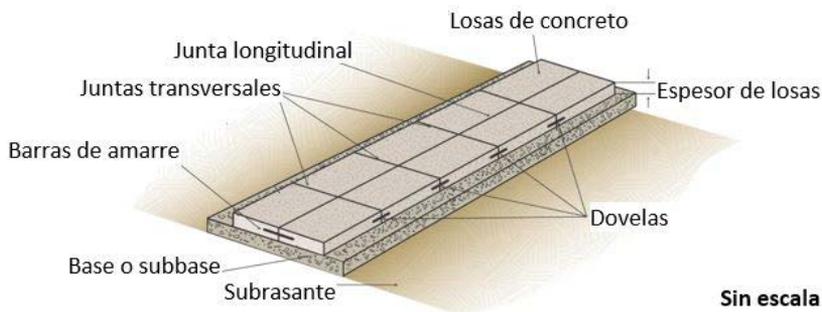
Esquema de pavimento de concreto articulado (JPCP) con dovelas
